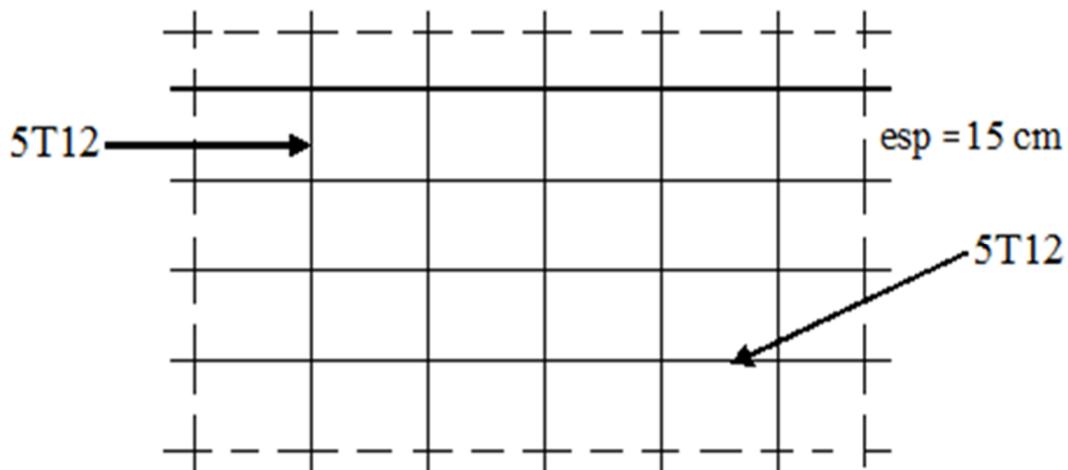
La disposition du ferrailage du voile 15cm.
